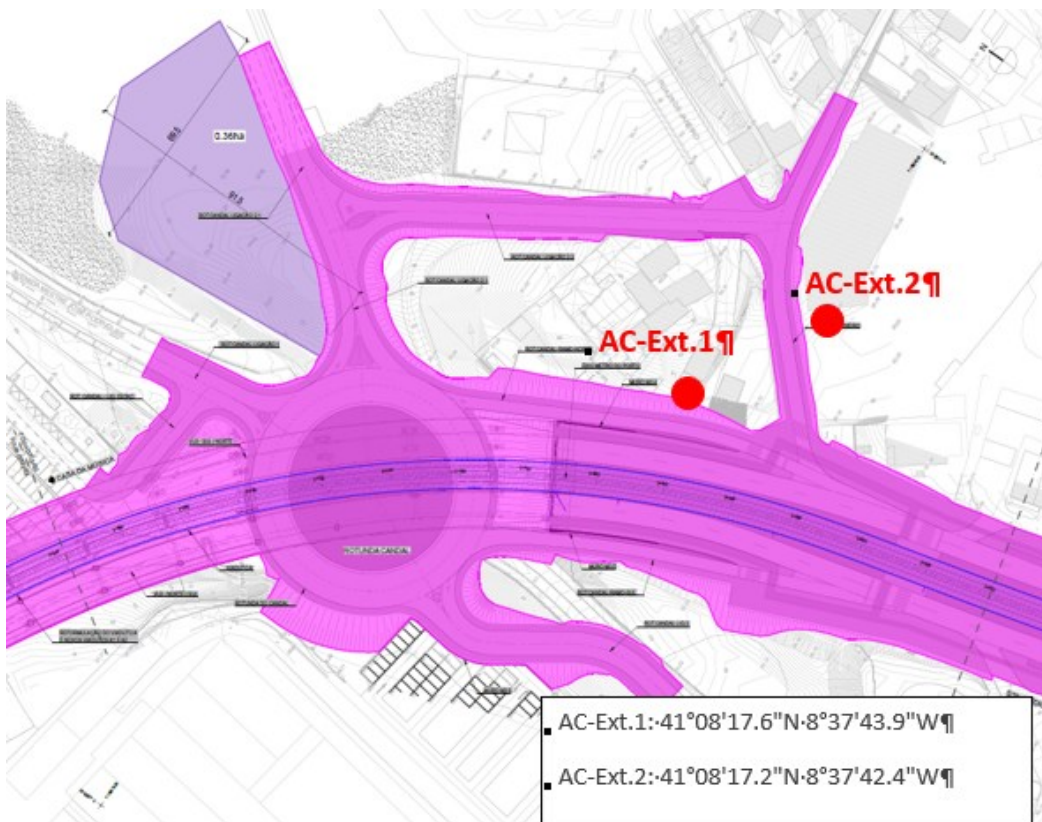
Pontos de monitorização Arrábida-Candal (vibrações – construção)
